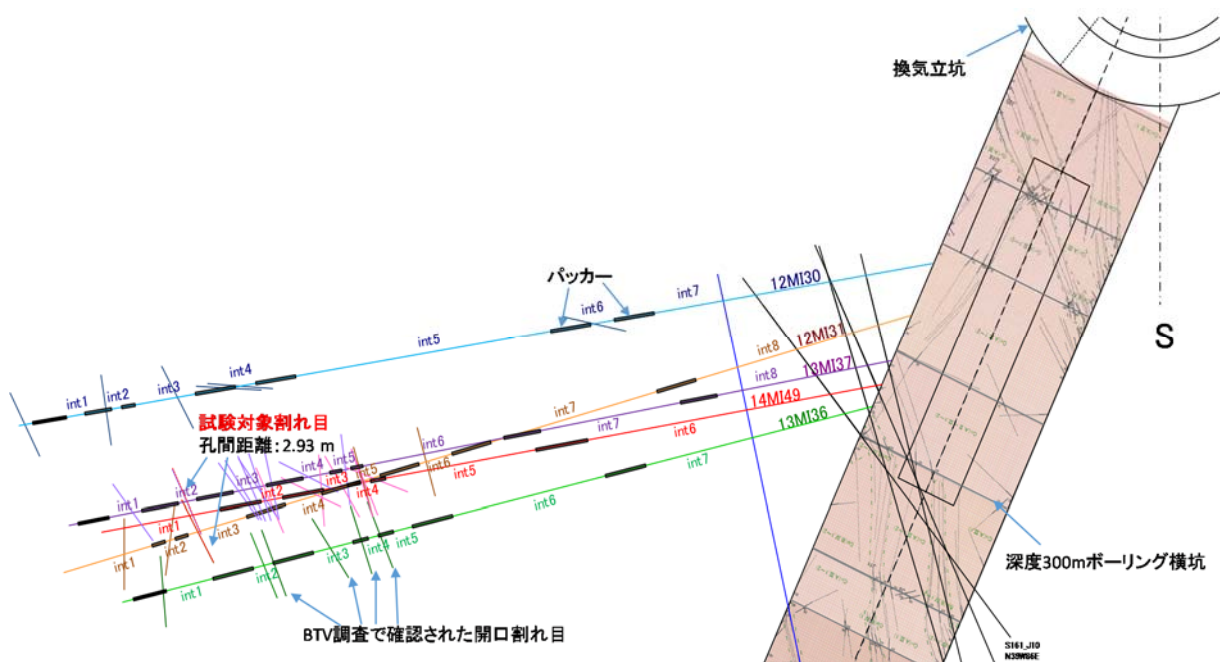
試験対象割れ目とボーリング孔配置の平面図
